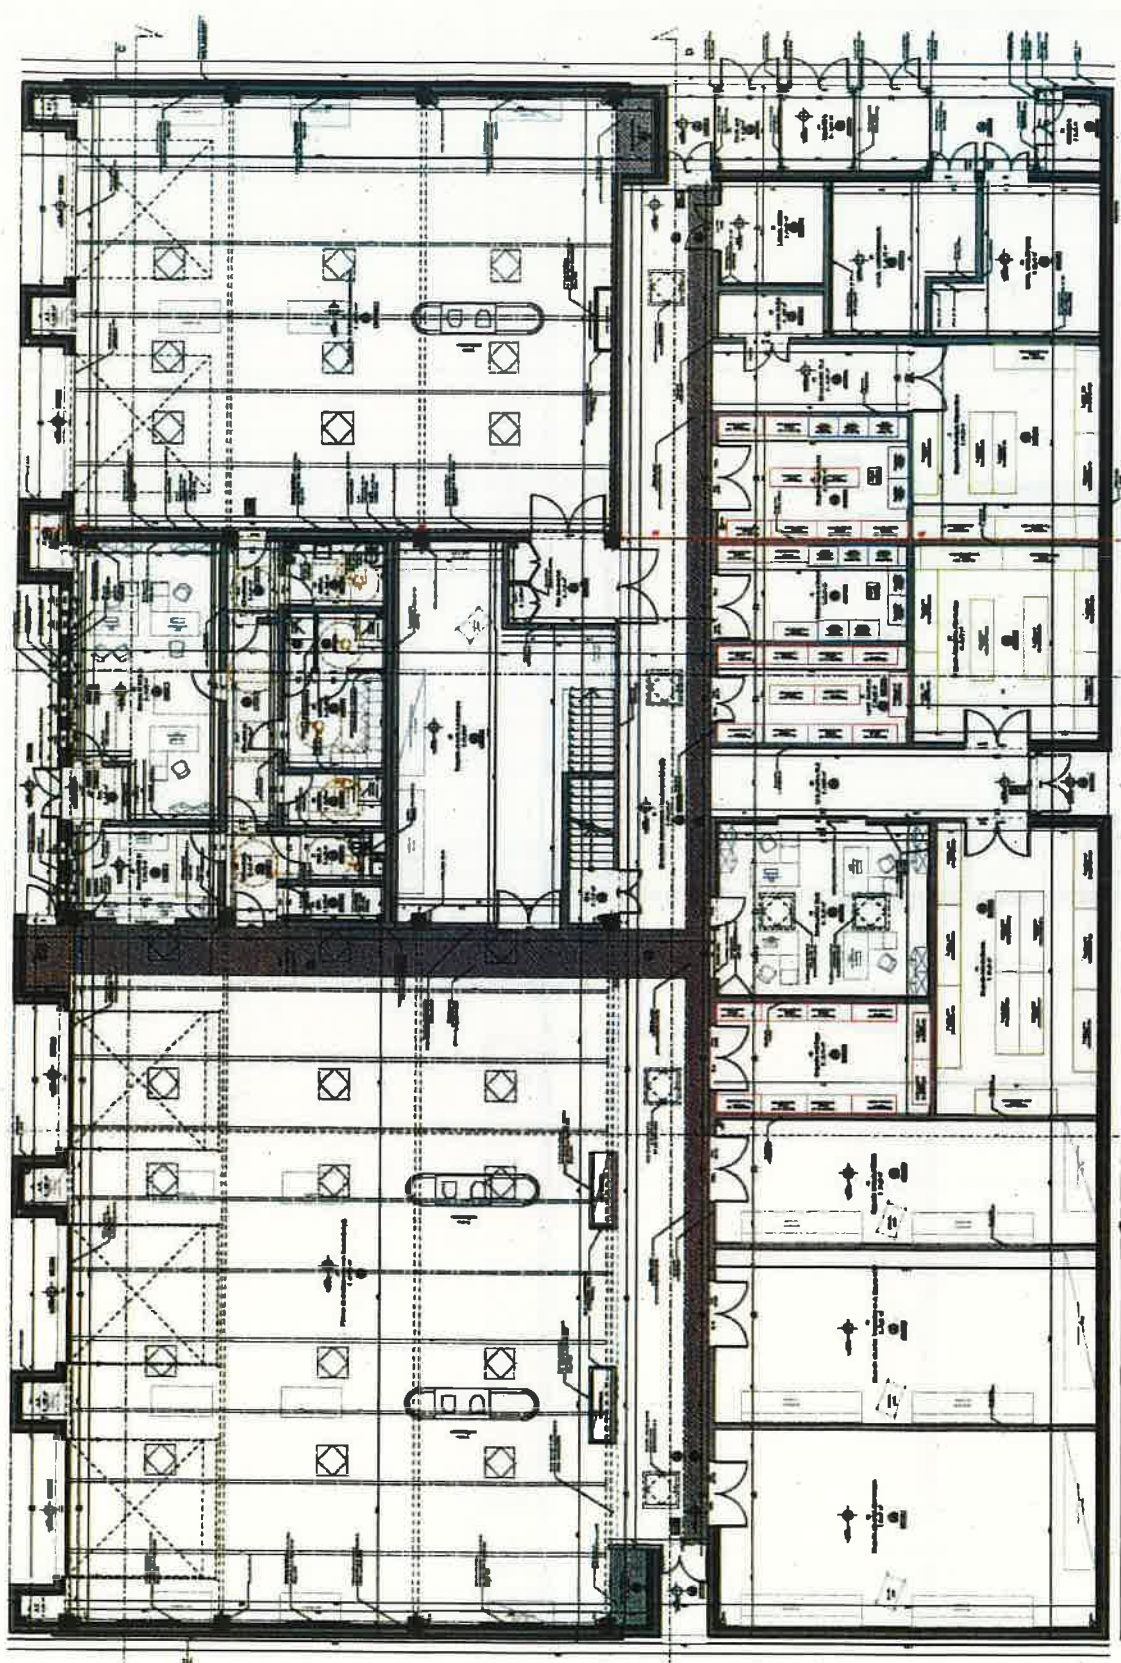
Plan de masse du rez-de-chaussée du bâtiment projeté NT12 (source : 3^e RMAI, réélaboration : cabinet d'architecte BPM)
